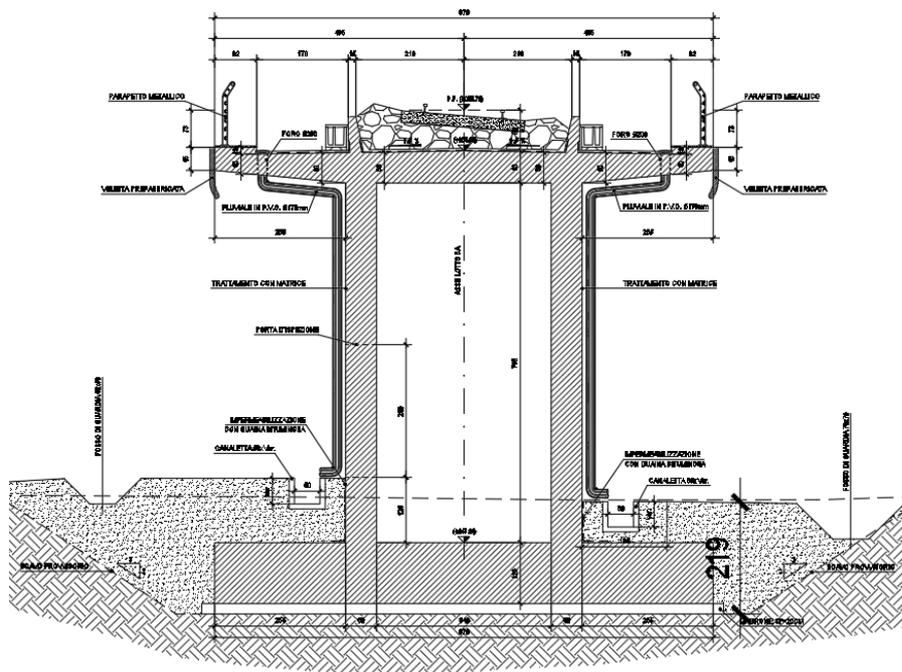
Sezione trasversale Manufatto scatolare di approccio ai viadotti
